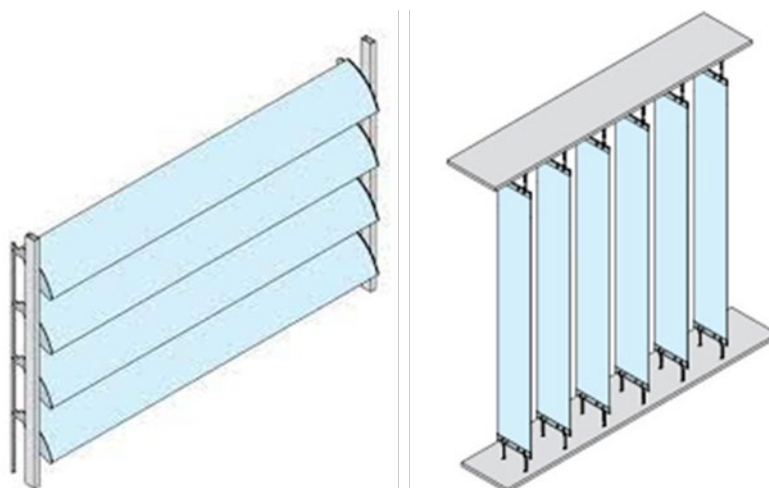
Imagens de elemento de proteção horizontal e vertical
